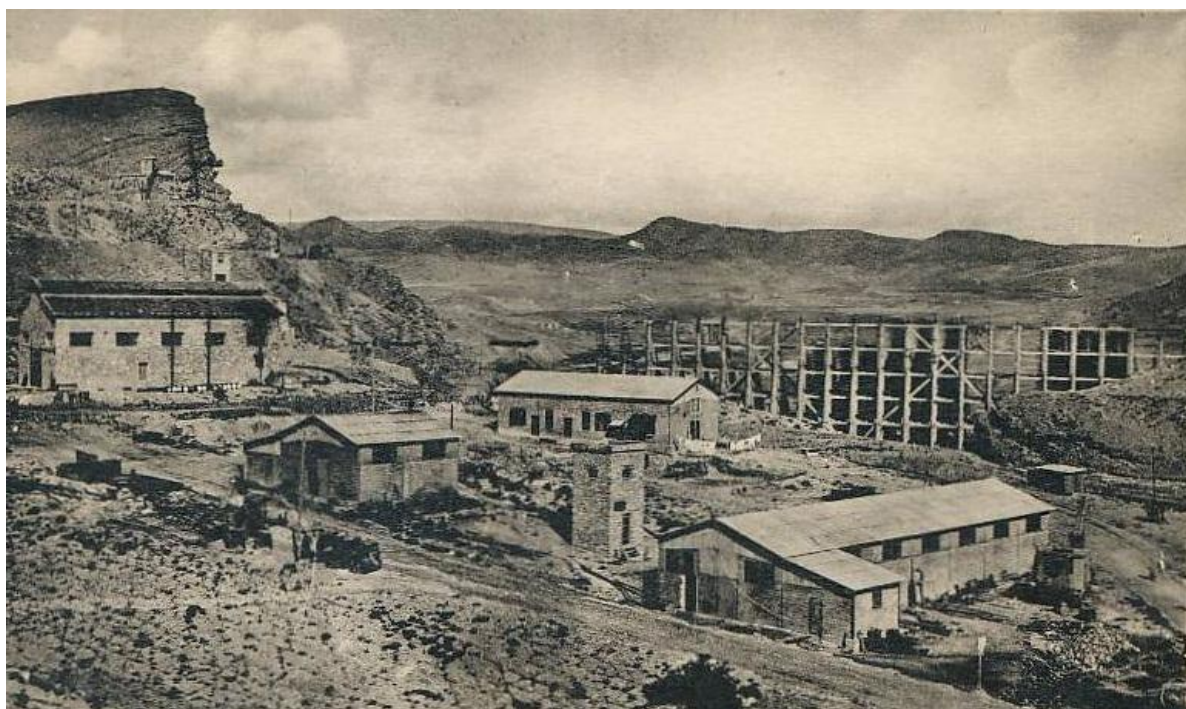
Vue sur le barrage K'sob lors de sa construction.
